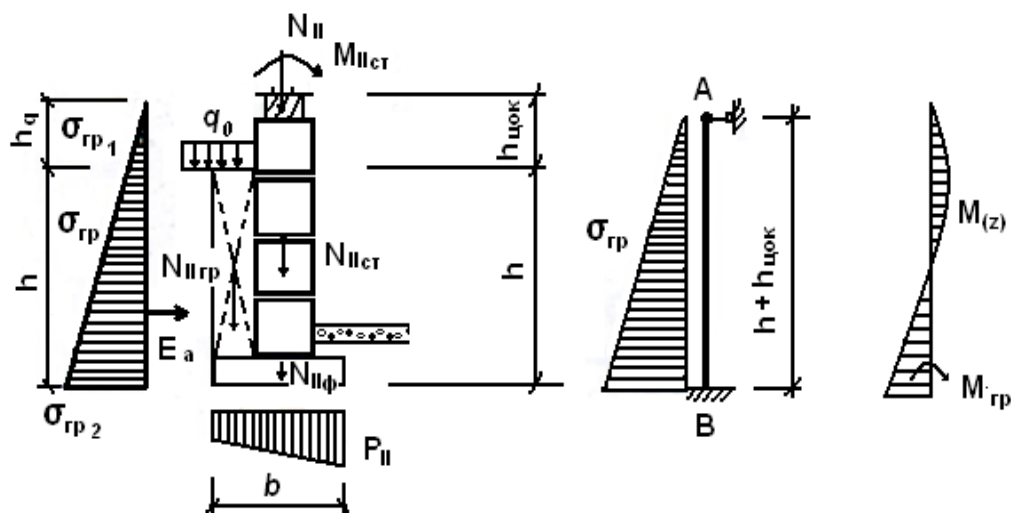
Розрахункові схеми будівель з підвалами та гнучкими перекриттями
